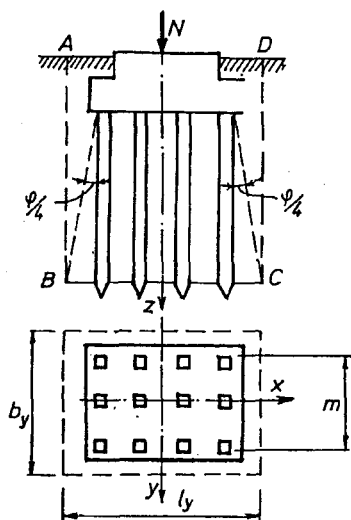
Схема условного свайного фундамента для расчета его осадки
